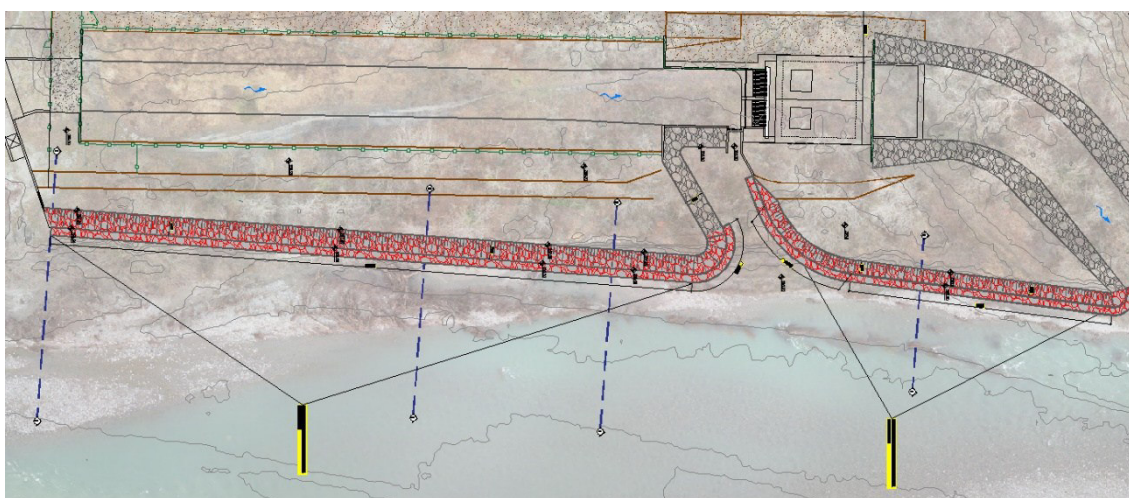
Stralcio planimetrico con l’indicazione delle due difese spondali previste
